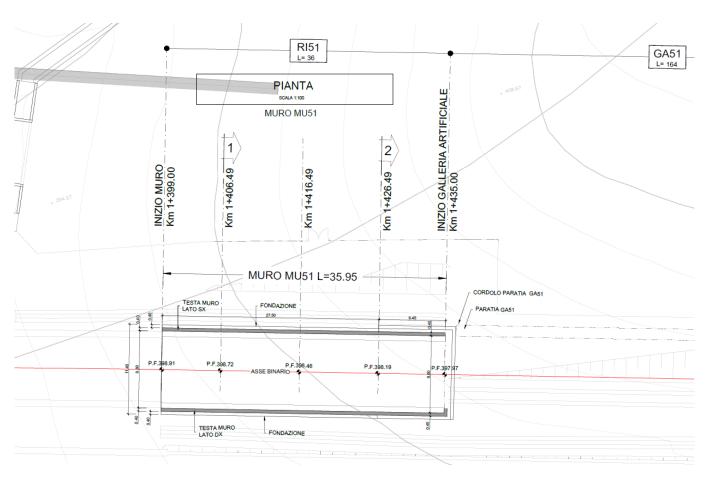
RI51: Muro a U MU51 – Pianta.
